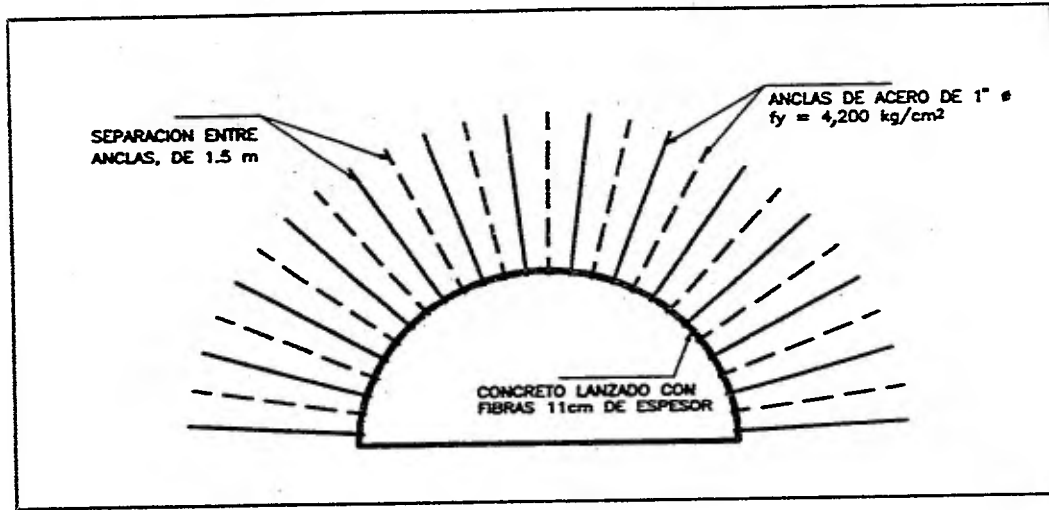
Soporte definitivo con anclas de acero y concreto lanzado con fibras de acero.
